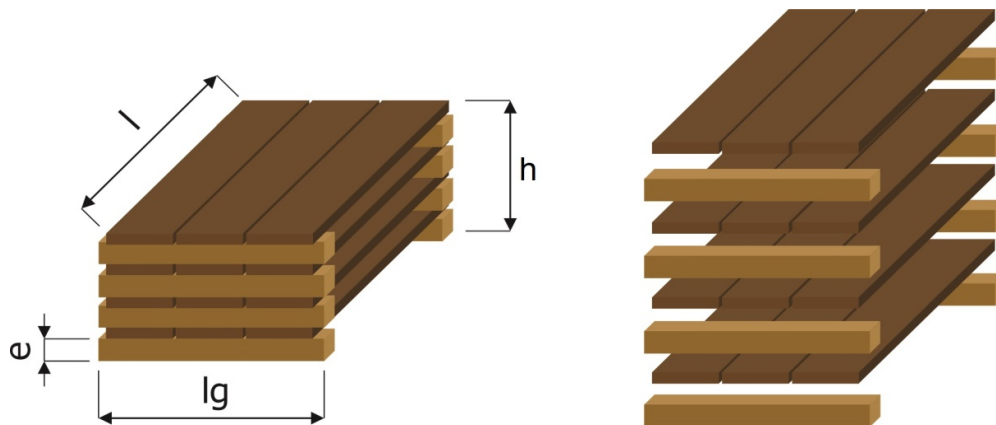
Madeira serrada armazenada com uso de tabique/sarrafo (FONTE: Desenho Elaborado Gilles Pierre - Cortesia).
